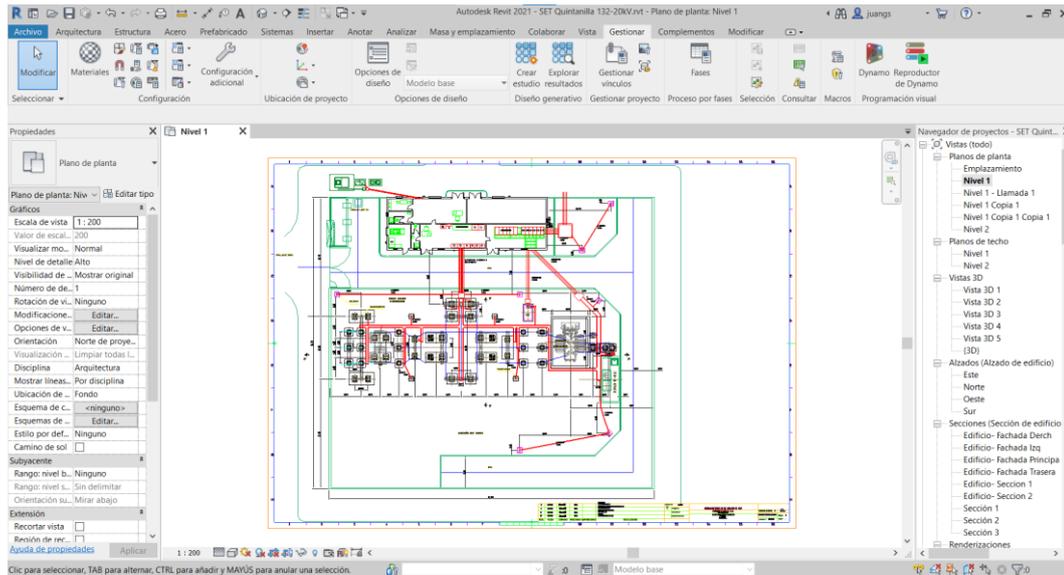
Plano de planta SET Quintanilla 132/20kV vinculado en Revit (Elaboración Propia)
